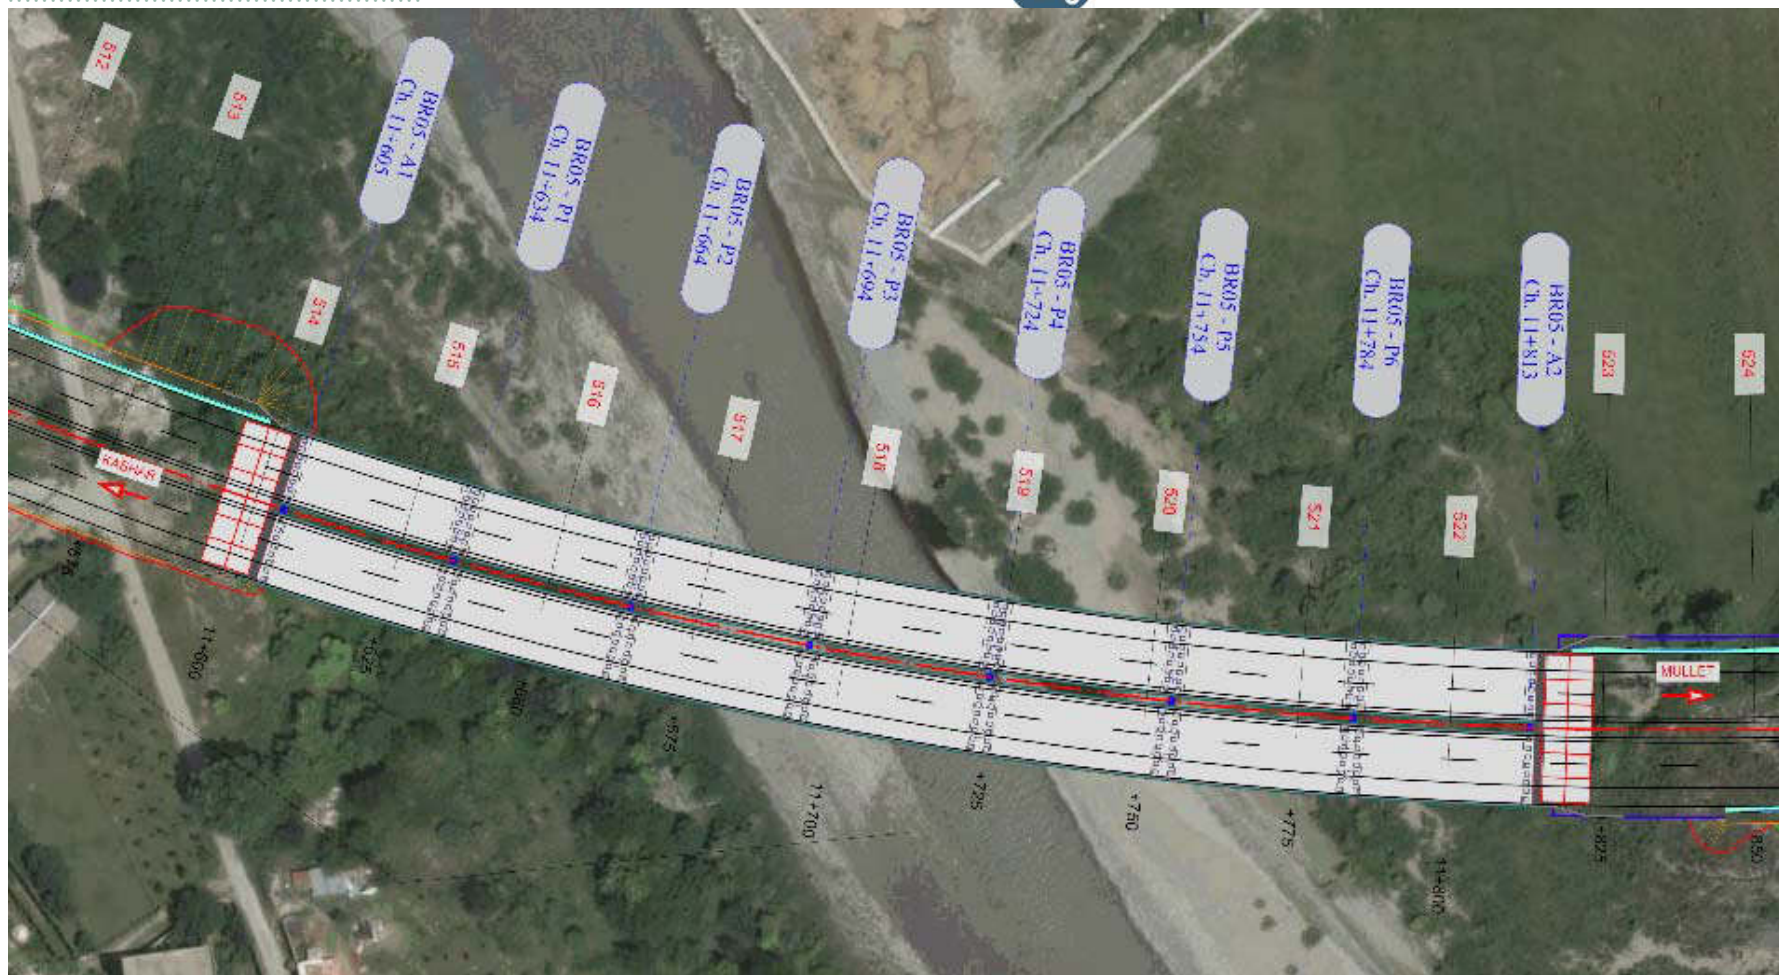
Pamje planimetrike e Urës 05, L=210m (Hapësira 7x30m)
